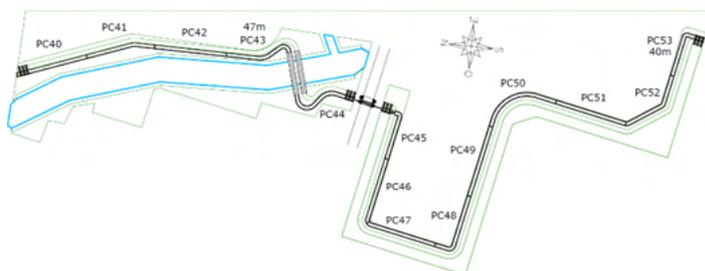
Divisão da pista de caminhada da Zona C em trechos de cinquenta metros.
